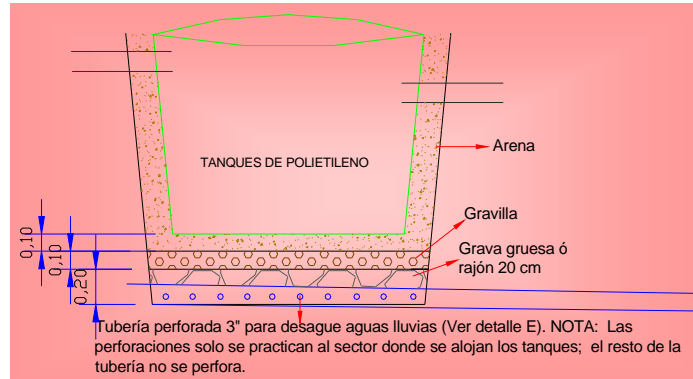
VISTA DE PLANTA Y DETALLES DE INSTALACIÓN DE TANQUES
